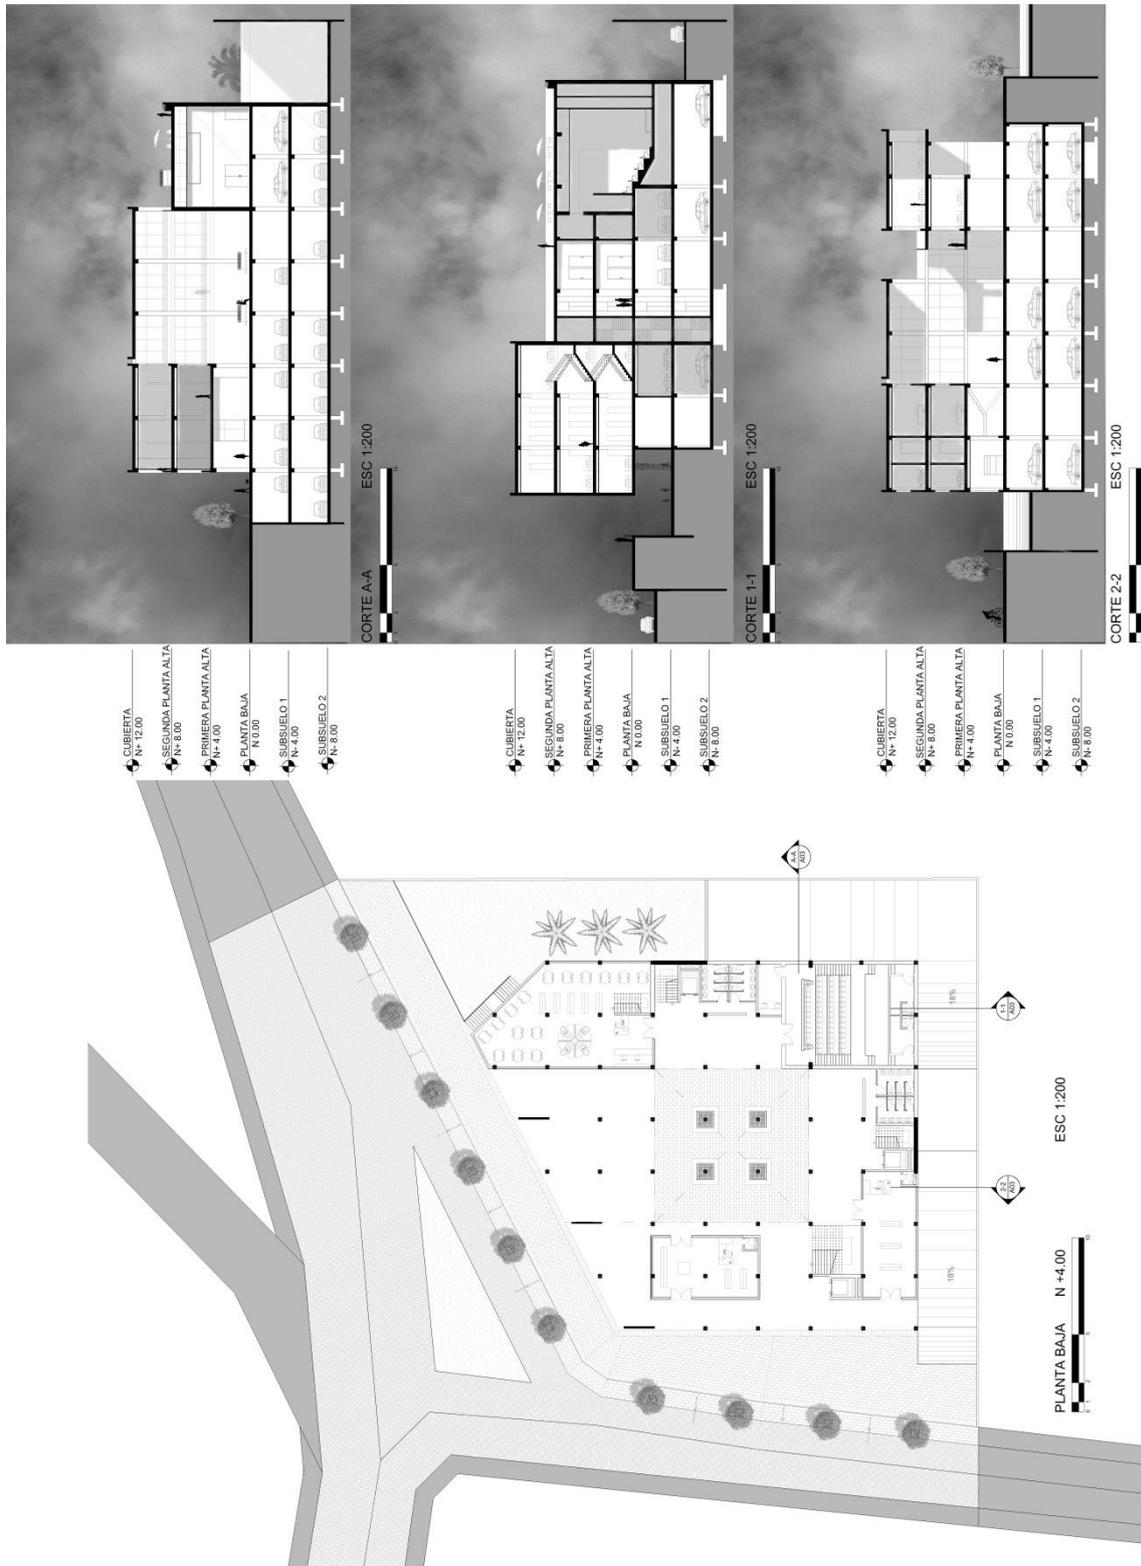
Planta Baja y Cortes. Elaboración Propia.
